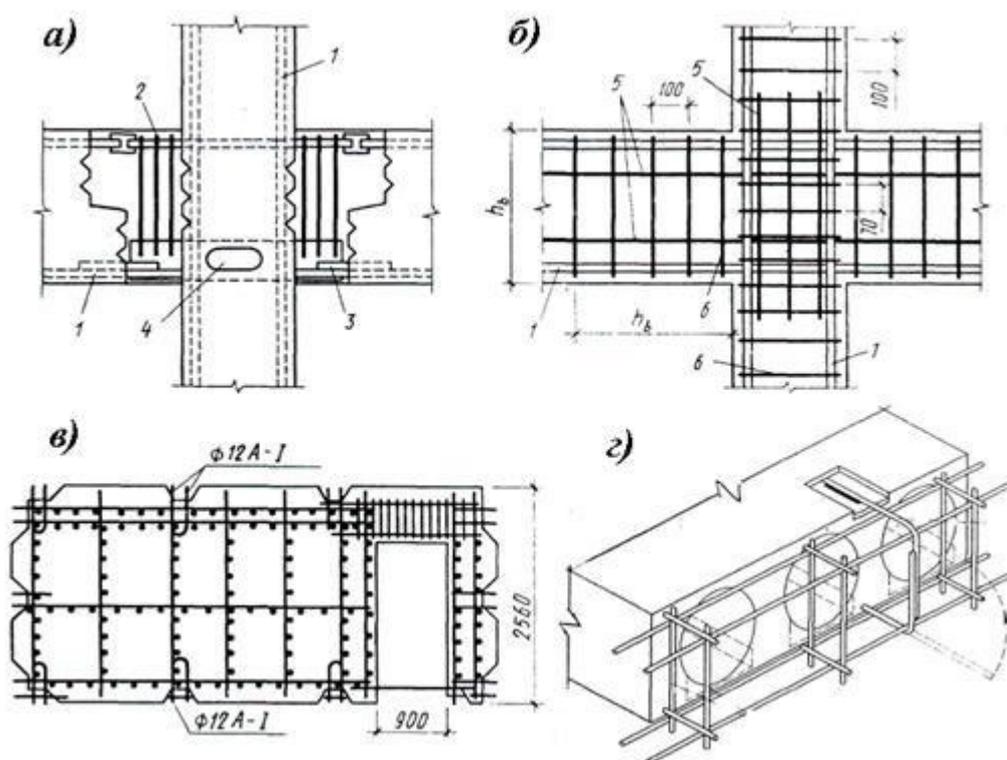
Сейсмостроительство узлов. а, б - армирование узла сборной и монолитной железобетонной рамы; в - конструктивное решение стыковых соединений панелей внутренних стен крупнопанельных зданий; г- анкеровка панелей перекрытий 1 - продольная арматура; 2 - то же, поперечная; 3 - усиленный арматурный выпуск; 4 - опорный столик из уголков с отверстием; 5 - дополнительная продольная арматура; 6 - поперечная арматура.
